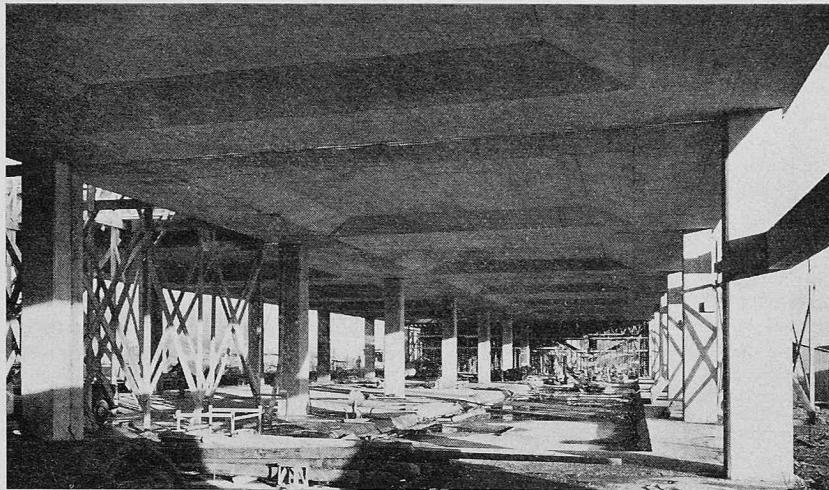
Die abgebildete Kassettendecke, welche in Querrichtung teilweise vorgespannt ist, wurde bereits drei Tage nach dem Betonieren ausgeschalt. Ein rationeller Einsatz von Gerüst und Schalung wurde dadurch ermöglicht
